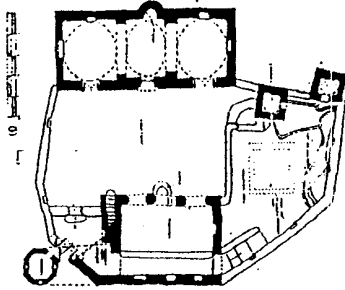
مسقط أفقى لمسجد طلختان باب قرب مرو (عن : Kuban) .
